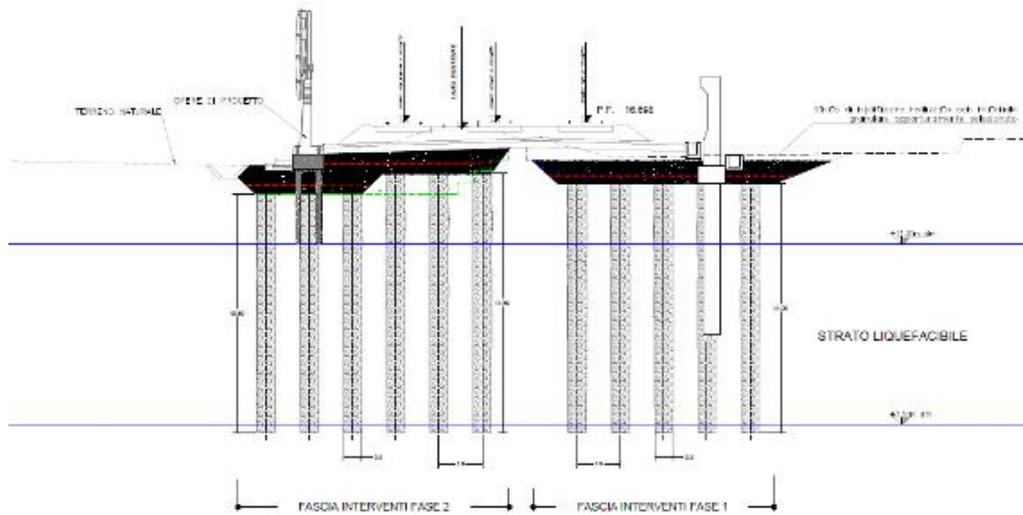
Sezione tipo con consolidamento con pali in ghiaia
